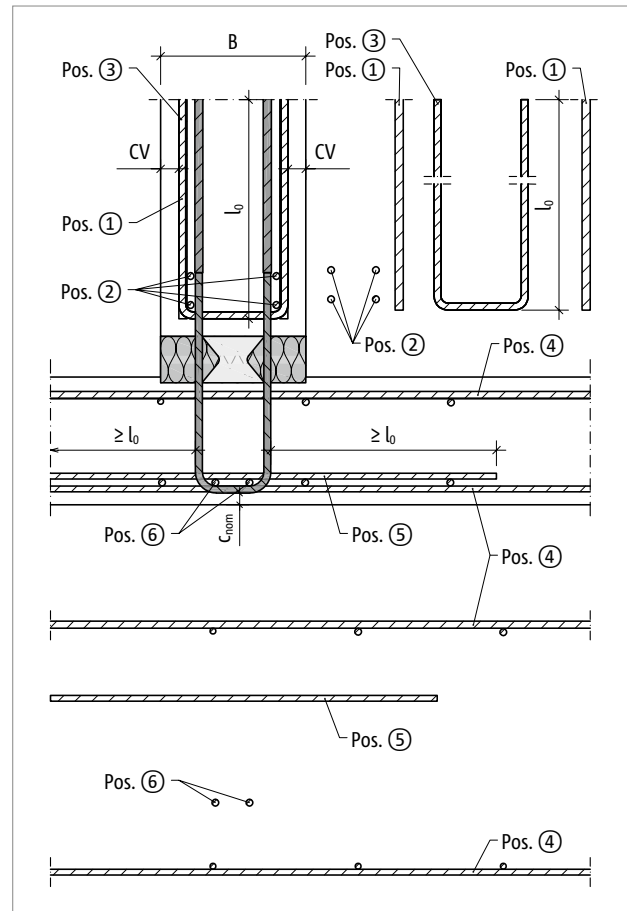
Schöck Sconnex® type W-NT-B : renforcement sur site dans le cas d'un ancrage de l'effort de traction dans la dalle avec une armature supplémentaire en Pos. 5
